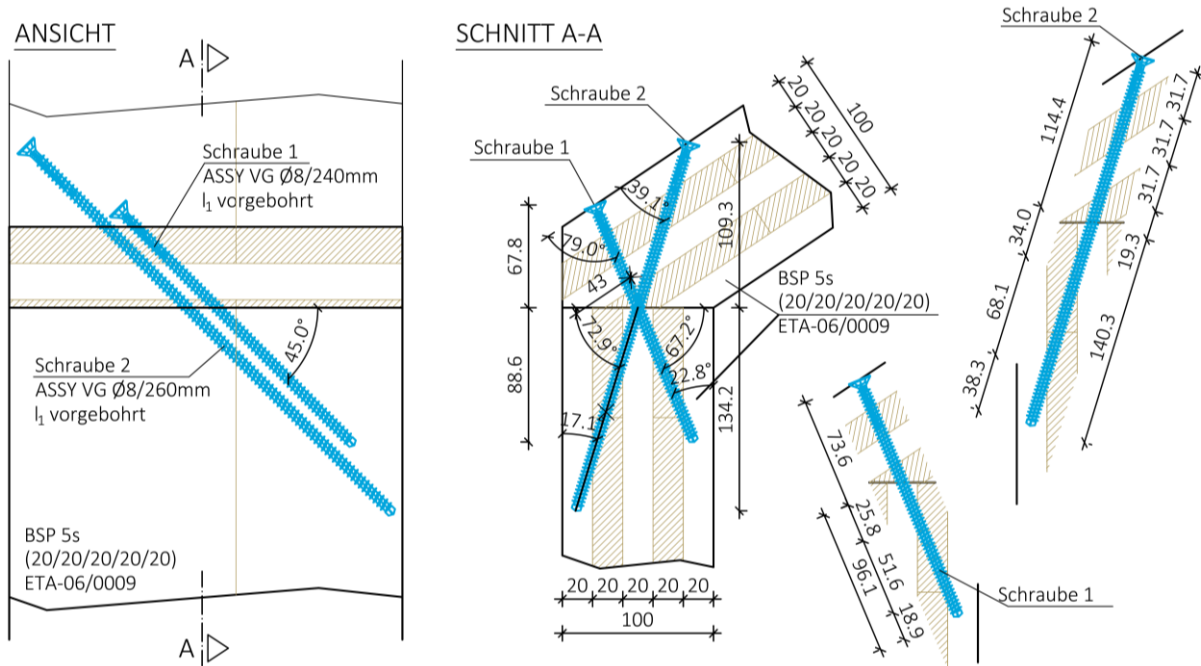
Detail B2 – „Schraubenkreuz 45°“
